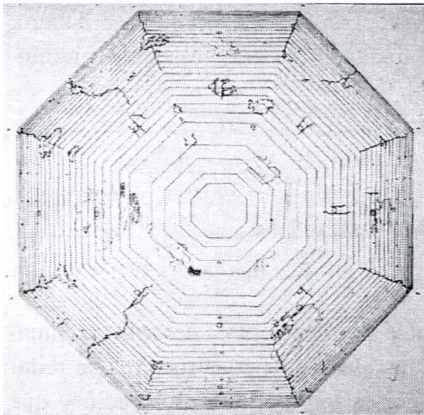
Grietas existentes en la cúpula de Santa María de la Flor
